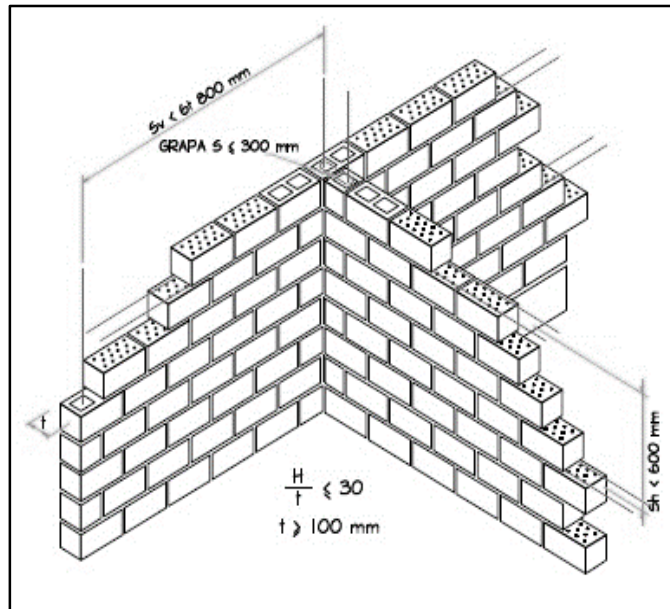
Mampostería Reforzada Interiormente, (Jean & Pérez, 2003).
